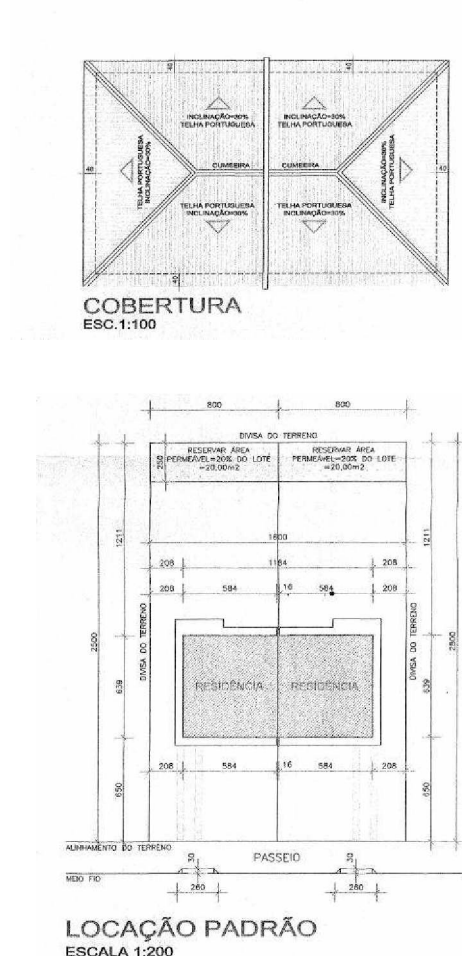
Planta Unidade Habitacional (telhado, locação).
